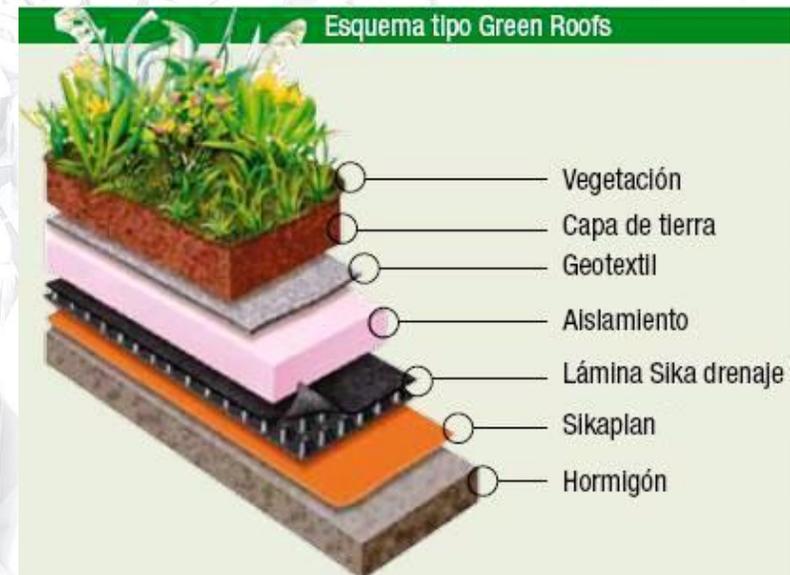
(GSA Ingeniería LTDA - Sistema de Cubiertas Verdes / Green Roof)
